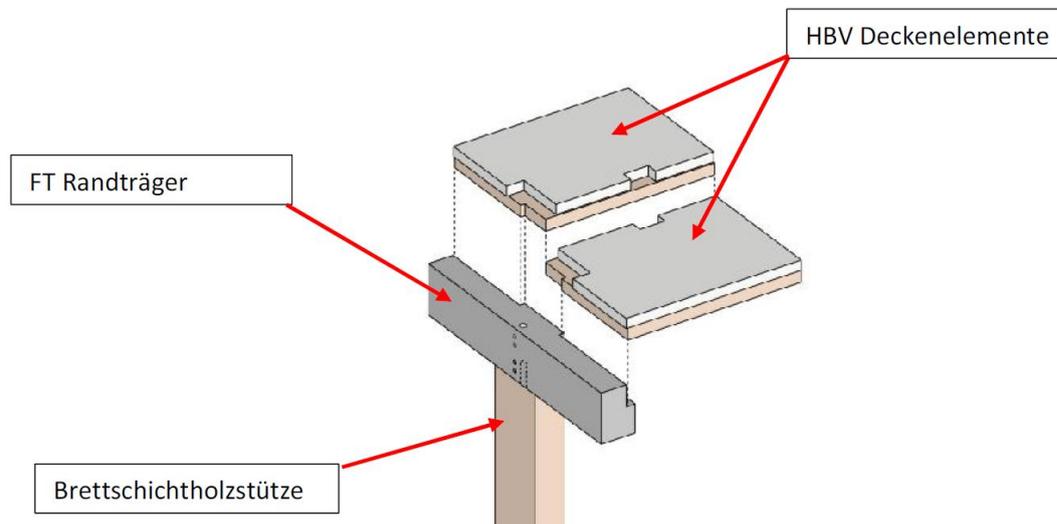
Holzbau Systemknoten (Stütze – Träger – Decke)
